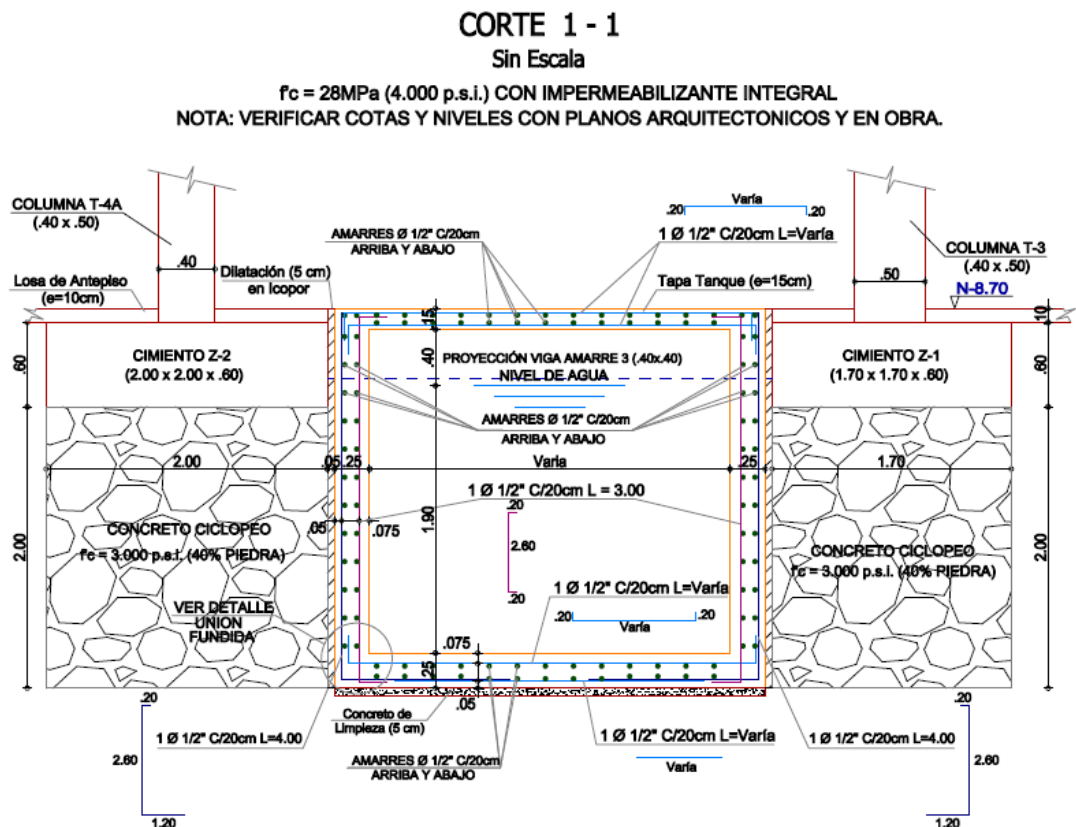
Corte transversal sección 1-1 tanque subterráneo.
